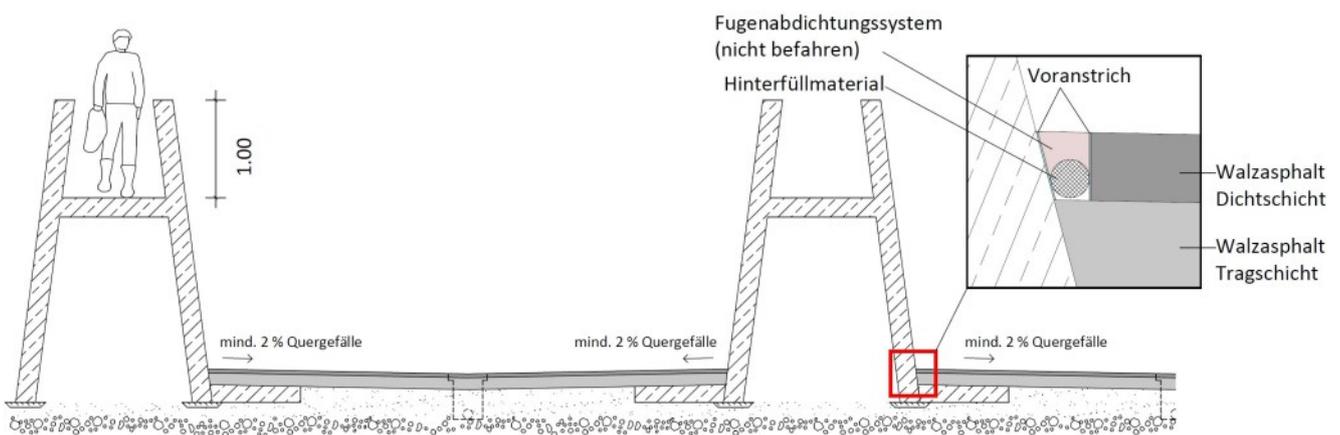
Asphalt - Betonfertigteil begehbar (schräge Wand)
